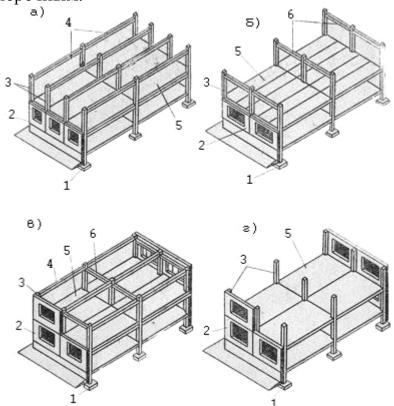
Конструктивные схемы каркасных зданий: а – с поперечным расположением ригелей; б – с продольным расположением ригелей; г – безригельное решение; 1 – столбчатый фундамент; 2 – наружная самонесущая стена; 3 – колонны; 4 – ригели, уложенные поперек здания; 5 – панели междуэтажного перекрытия; 6 – ригели, уложенные вдоль здания
